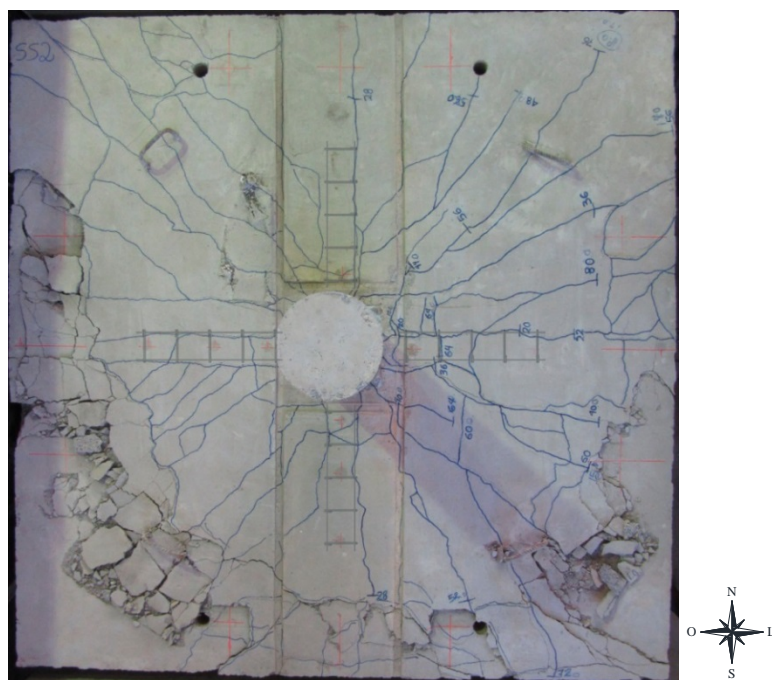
Mapa de fissuração (laje SS2)
